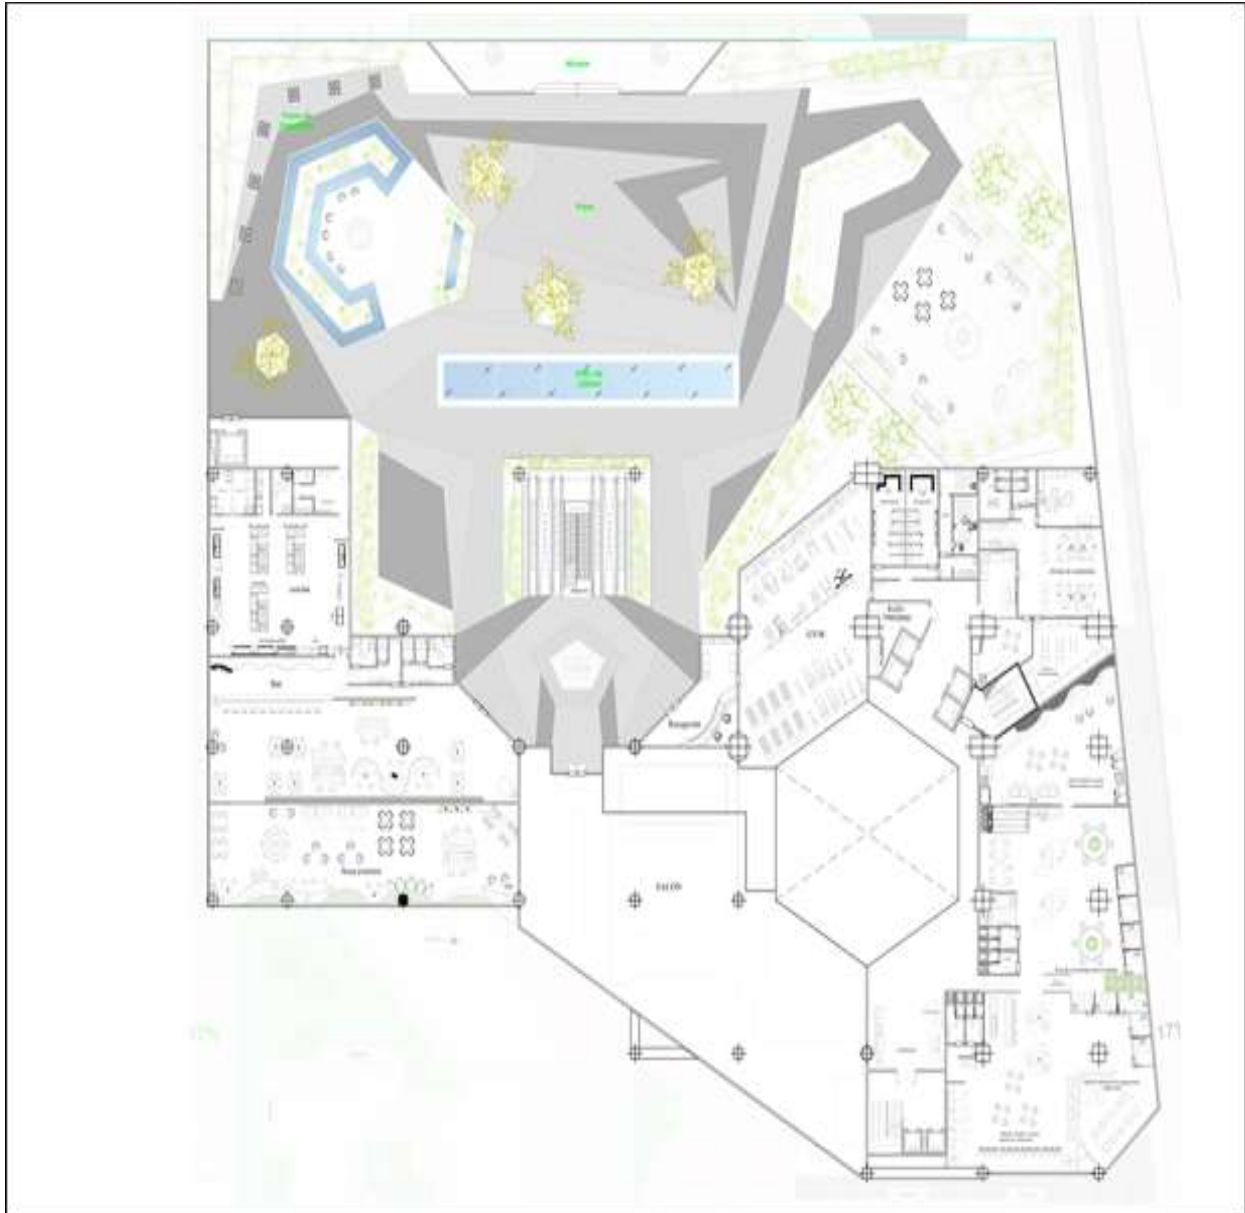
Nivel Acceso + 0.60 (Planta Baja). Fuente: El Autor (2023)
